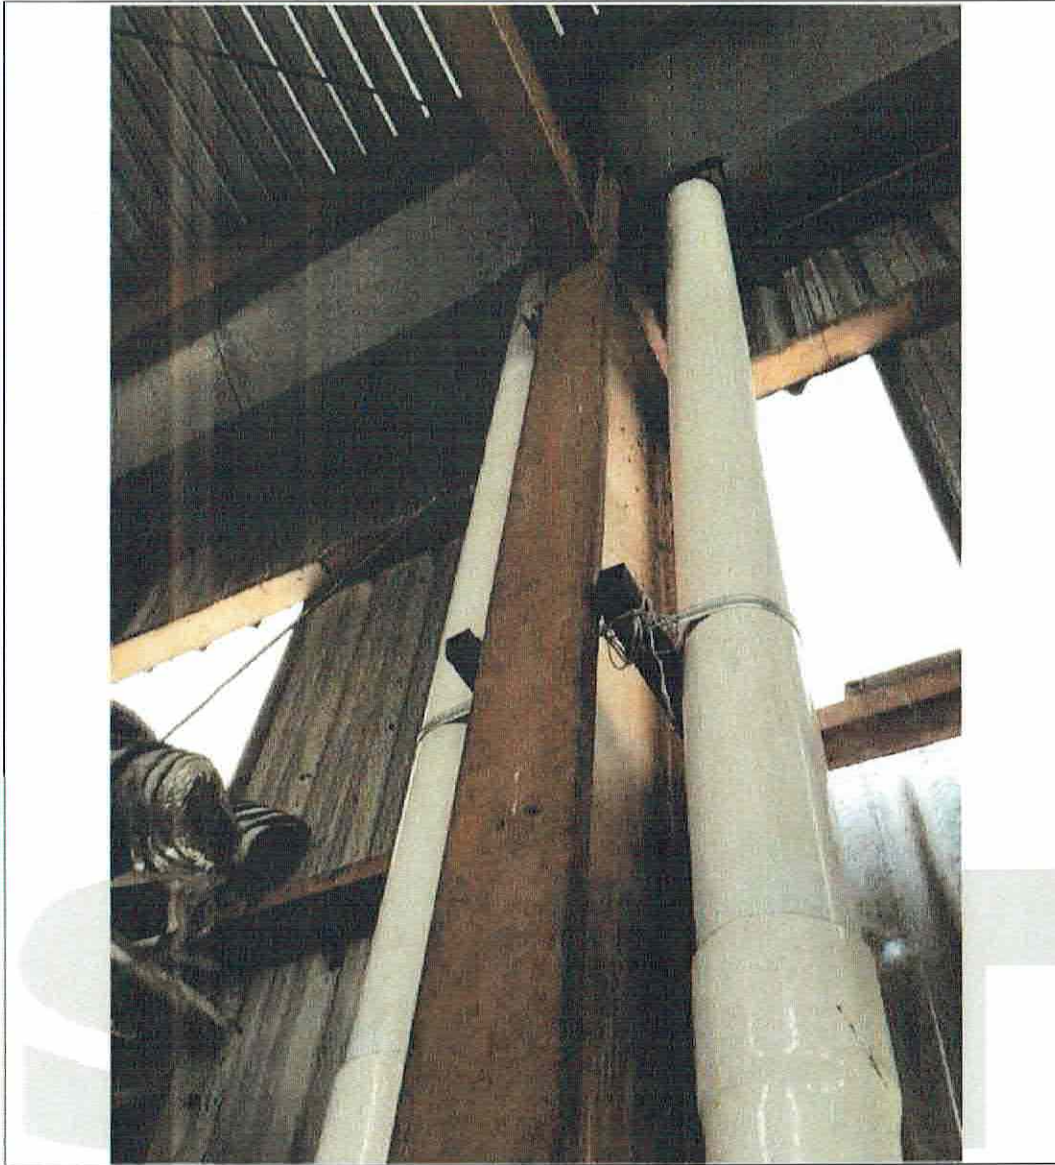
Columna, trabes y largueros correspondientes a Bodega No. 1.
